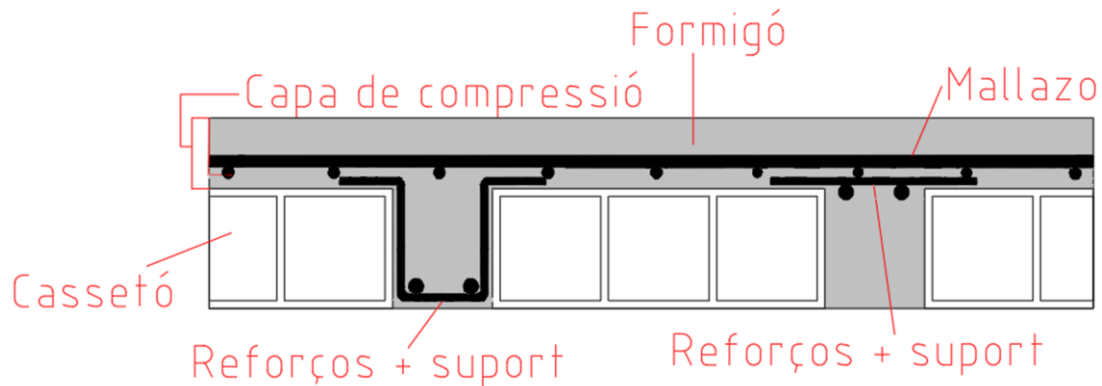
Esquema d'un forjat bidireccional reticular. *Elaboració pròpia.
